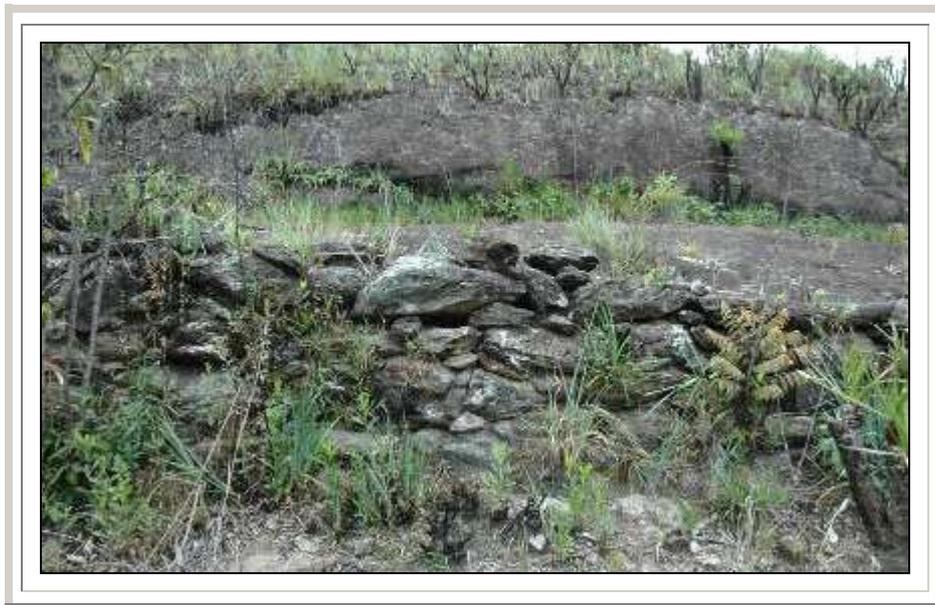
Detalhe de estrutura de corte e arrimo de pedras no Caminho Novo, segmento Ouro Branco – Ouro Preto
